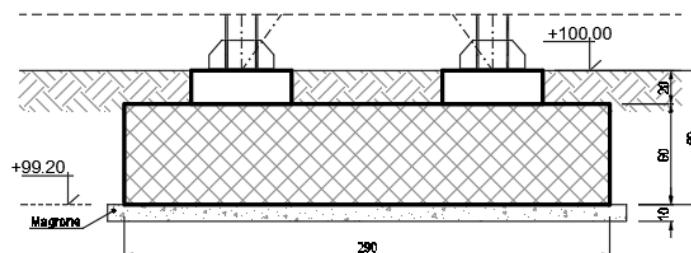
Sezione A-A della fondazione – Plinto tipo
